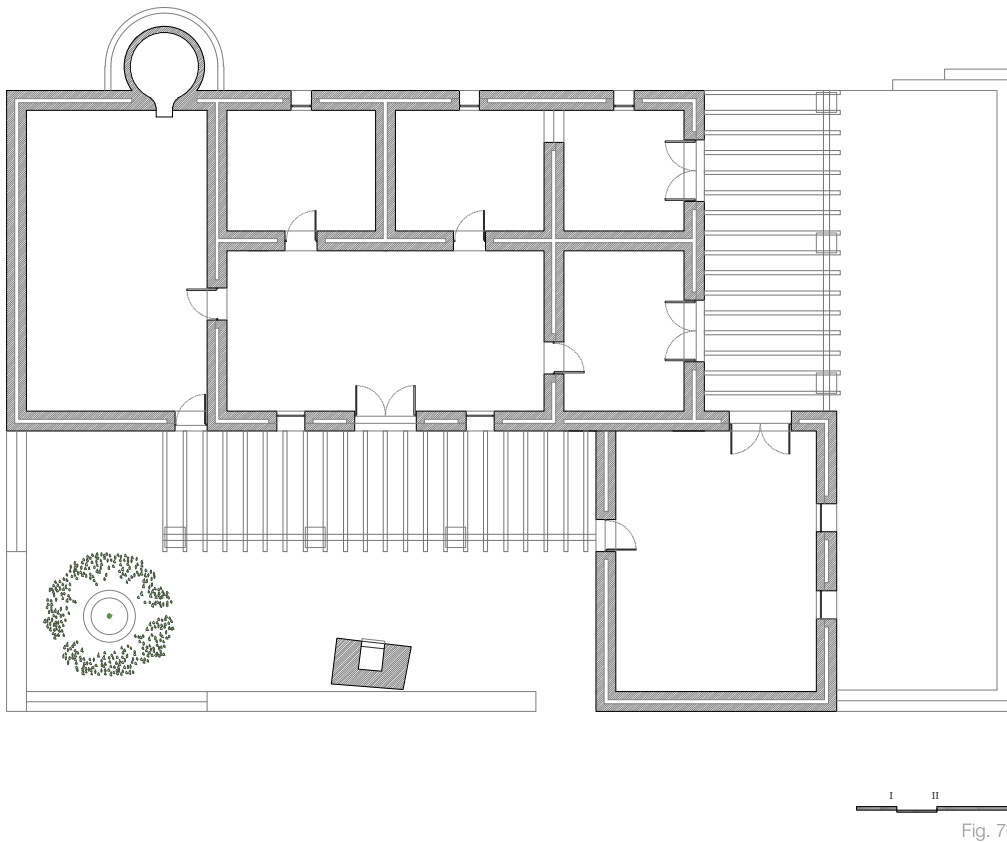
Planta modificada de la vivienda Can Toni d'en Jaume Negre
